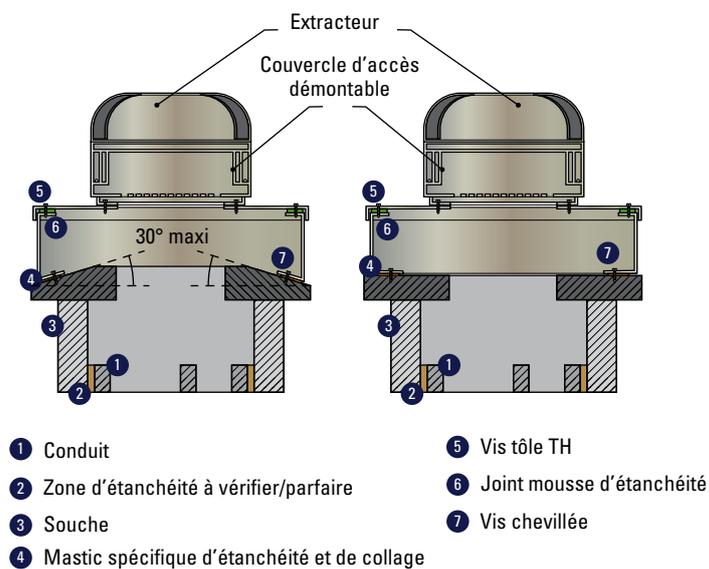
Préparation des conduits avant pose du plenum et de l'extracteur (cas dalle non conservée)
